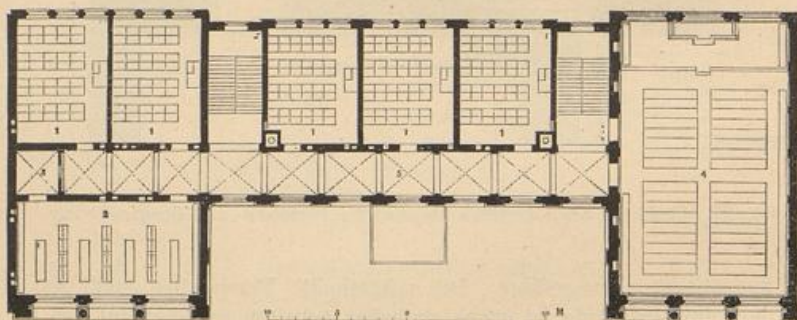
Grundriss vom zweiten Stockwerk.
